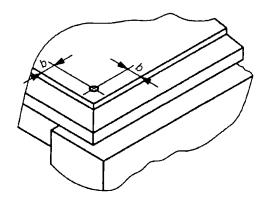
Конструкційне монтування прямокутних крайок, що укладають поперек на балках та утримують фахверками
